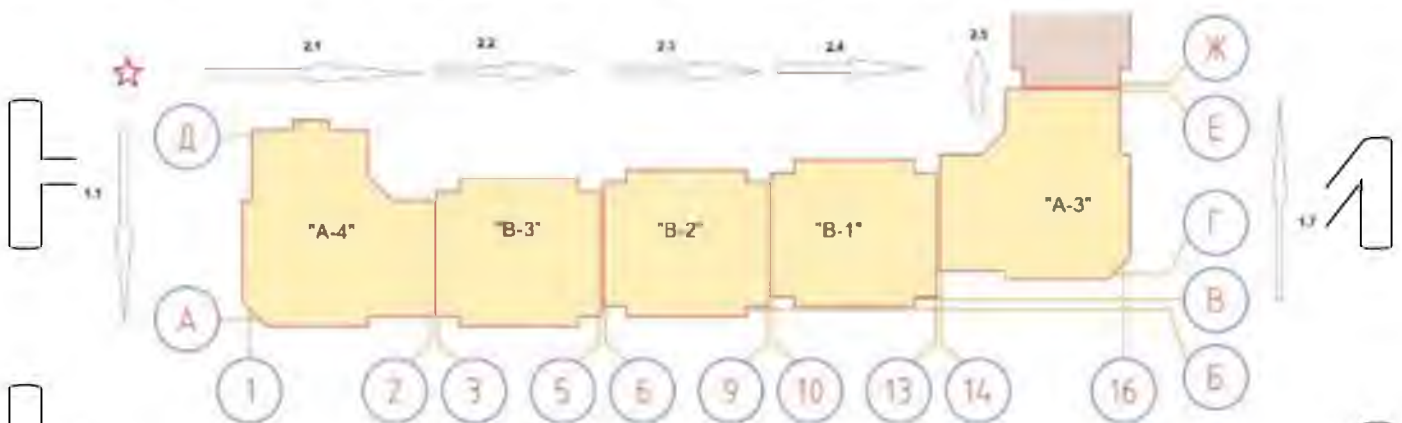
Послідовність виконання будівельно-монтажних робіт з навіски фасадної
